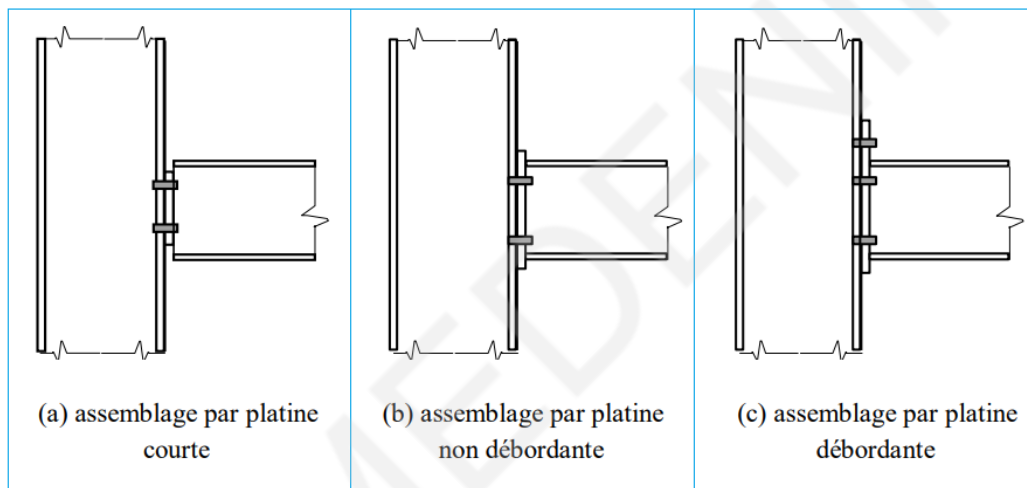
Assemblage poteau - poutre par platine d'extrémité boulonnée
